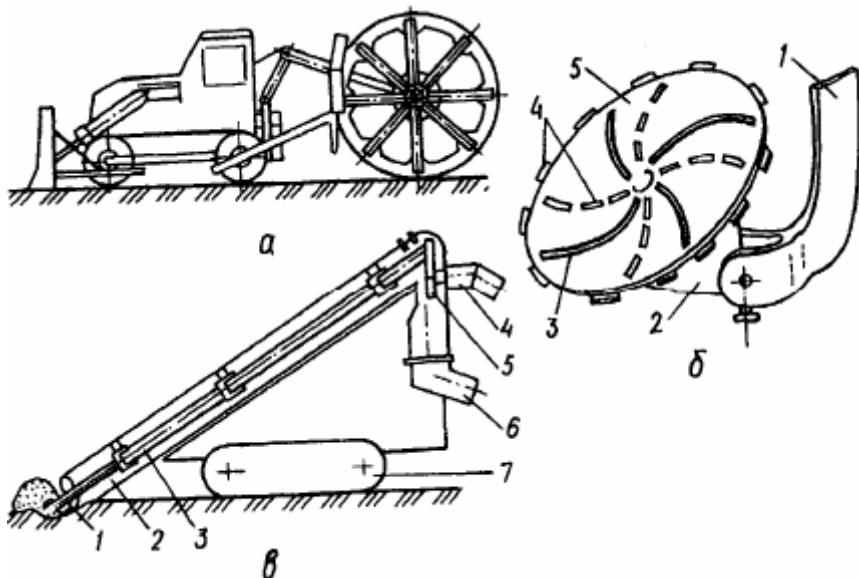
Дискові розпушувачі: а - дводисковий на базі бульдозера Д-687; б - однодисковий нахилений (1 - стояк; 2 - гідродвигун; 3 - транспортувальний елемент; 4 - різальний елемент; 5 - диск); в - розпушувач-навантажувач (1 - фреза; 2 - труба; 3 - вал; 4 - гідродвигун; 5 - ексцентриковий шків; 6 - бампер; 7 - трактор)
